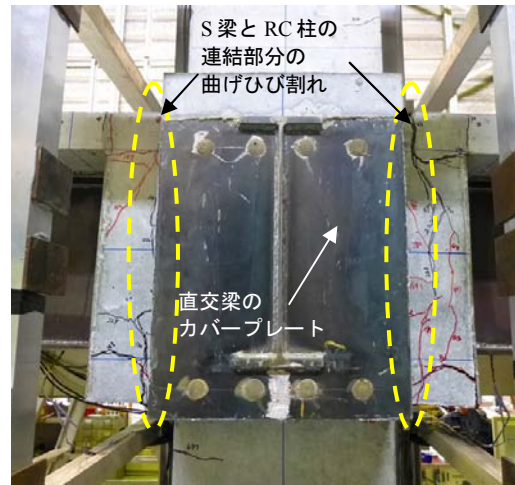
ひび割れ発生状況 (F60:R=+20×10⁻³rad)
